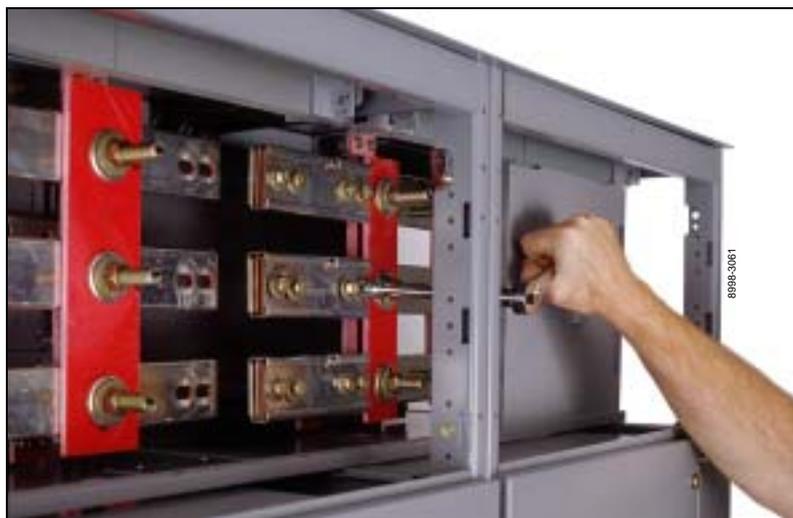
Desmontaje de los tornillos del conjunto de empalme
